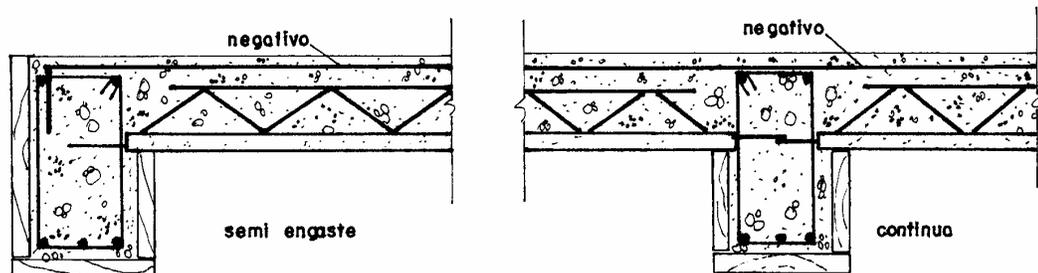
Apoio da laje treliça em estrutura de concreto armado
